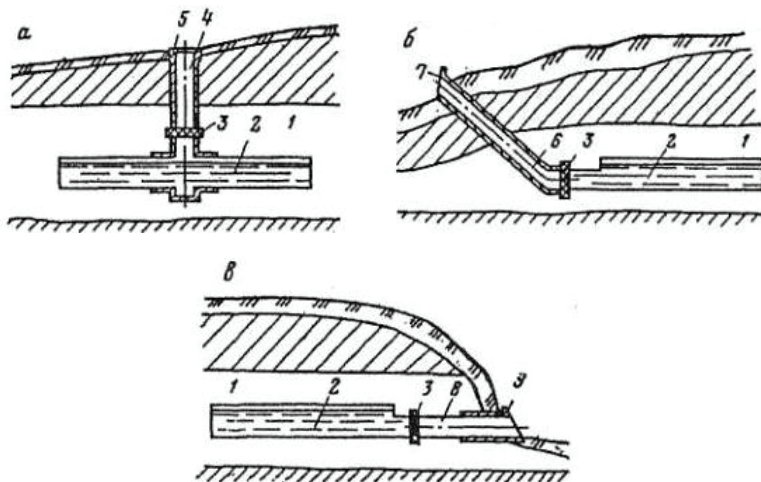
Схемы шахтных хранилищ с вертикальной (а), наклонной (б) и горизонтальной (в) вскрывающими выработками [140]:
